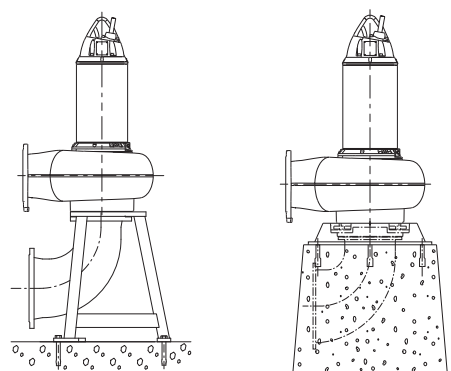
Сухая установка в вертикальном положении на основании (слева) и на плите на двух бетонных стойках (справа)
